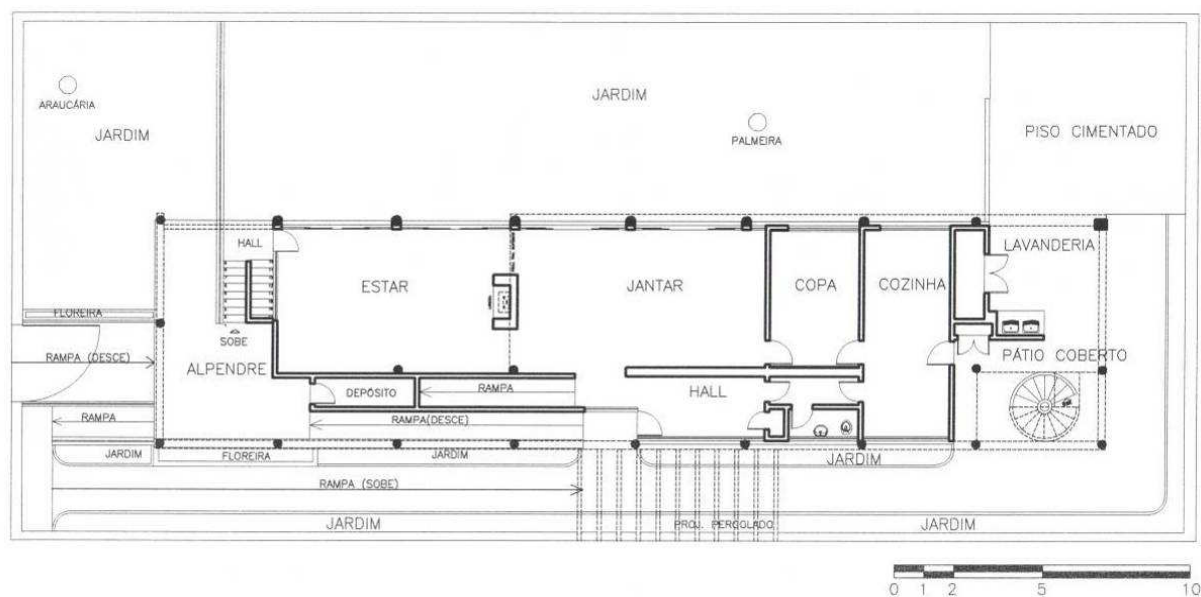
PLANTA DO PAVIMENTO TÉRREO
